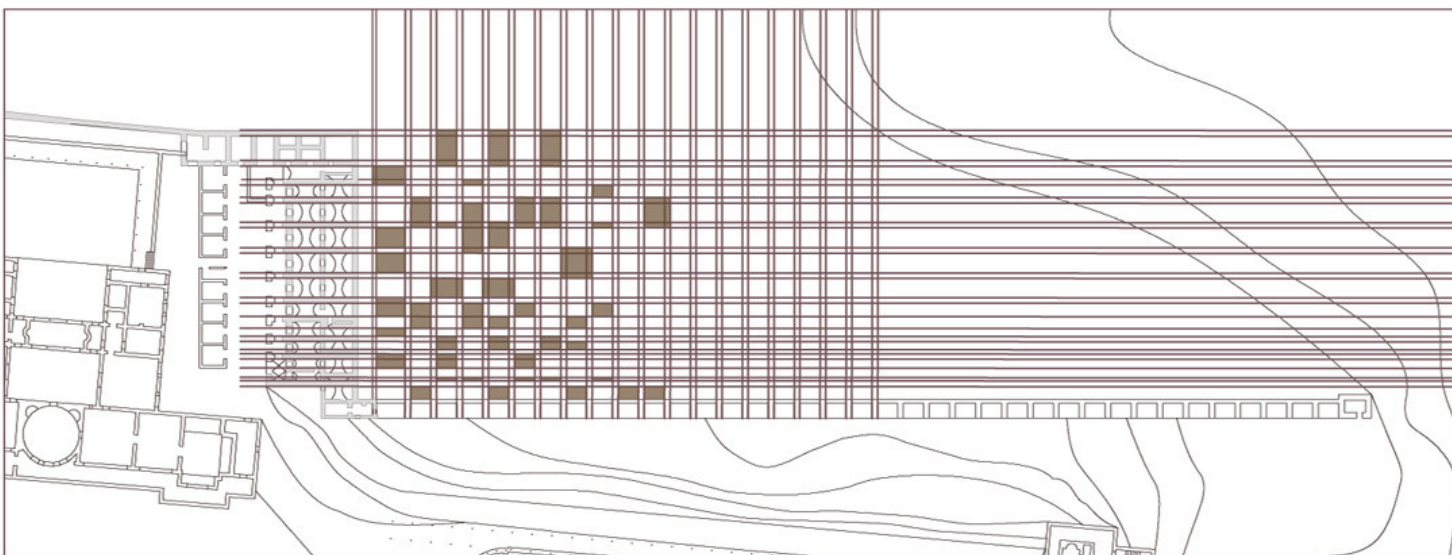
Planimetria con indicazione delle zone dove sono posizionate le tholos
